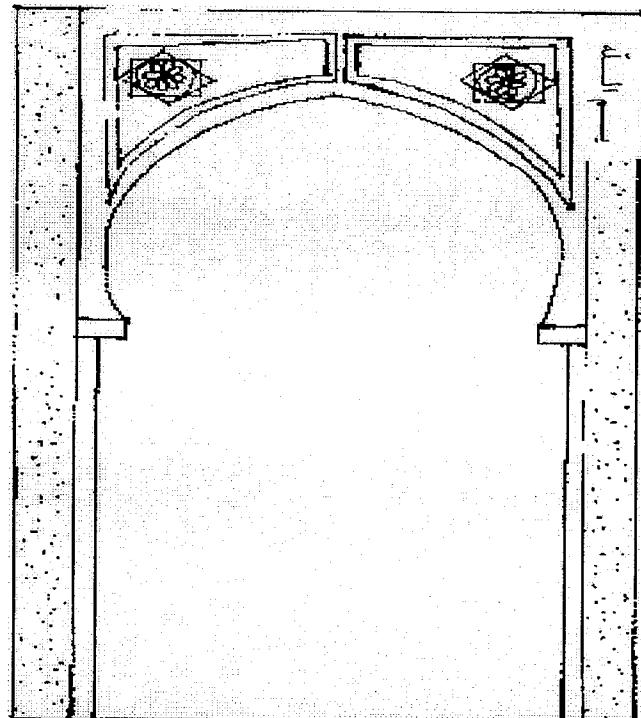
مخطط مسجد سيدى الحلوى
